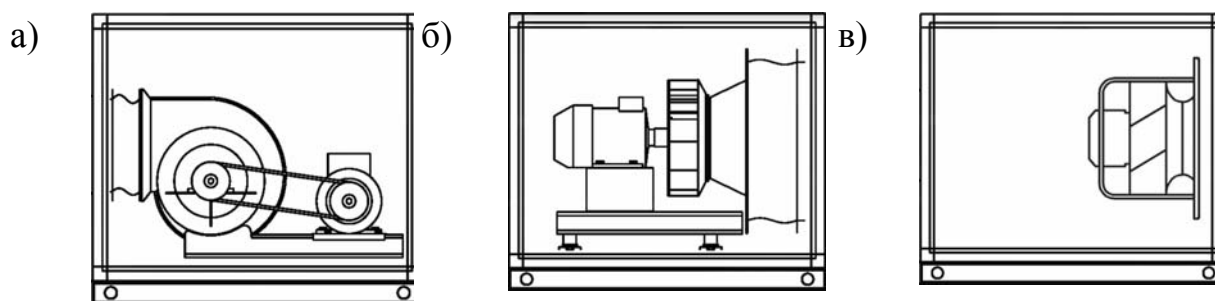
Варианты вентиляторных агрегатов: а – вентилятор с кожухом; б – вентилятор канальный с внешним двигателем; в – вентилятор с мотор-колесом
